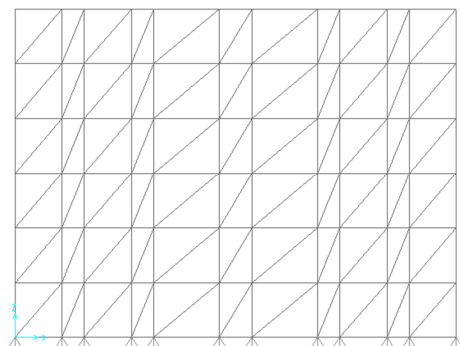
Configuração dos Planos de Contraventamento Vertical Com Elementos de Contraventamento Pequenos
